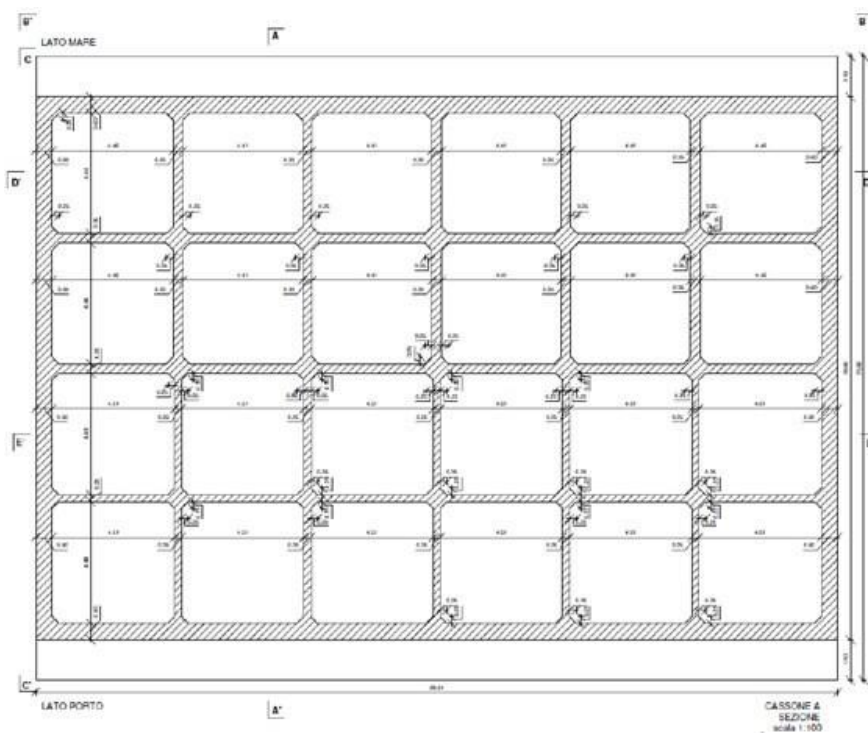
Cassone tipo A: carpenteria - Sezione orizzontale
